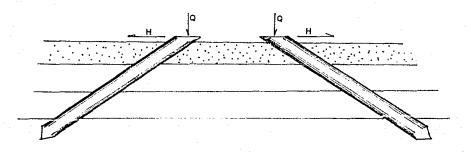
PILOTES INCLINADOS CON CARGA HORIZONTAL.
